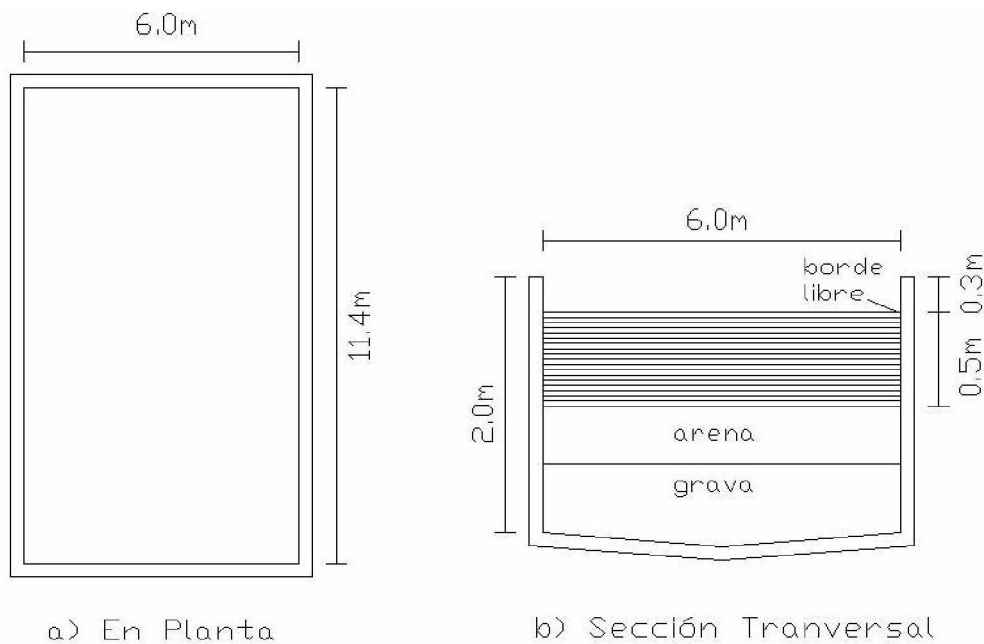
Esquemas del patio de secado de lodos para la Planta N°1
